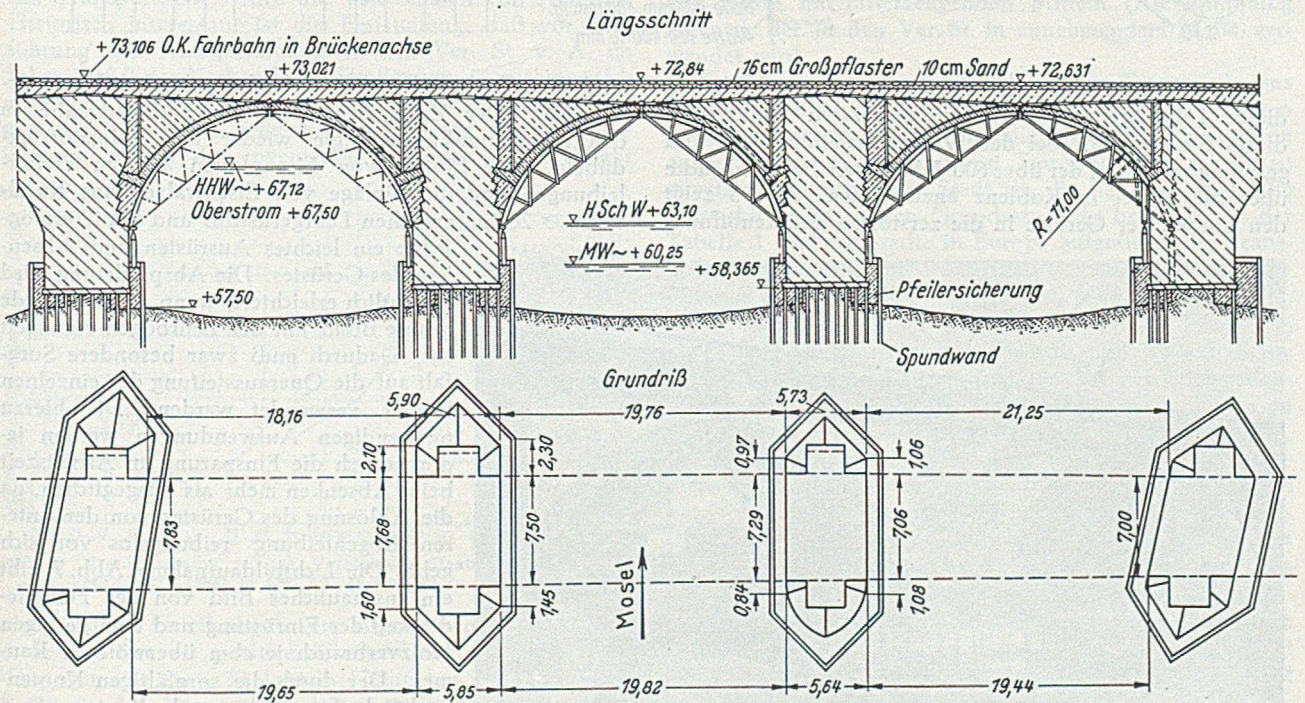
Übersicht über den Lehrgerüsteinbau, Baldinbrücke Koblenz.
